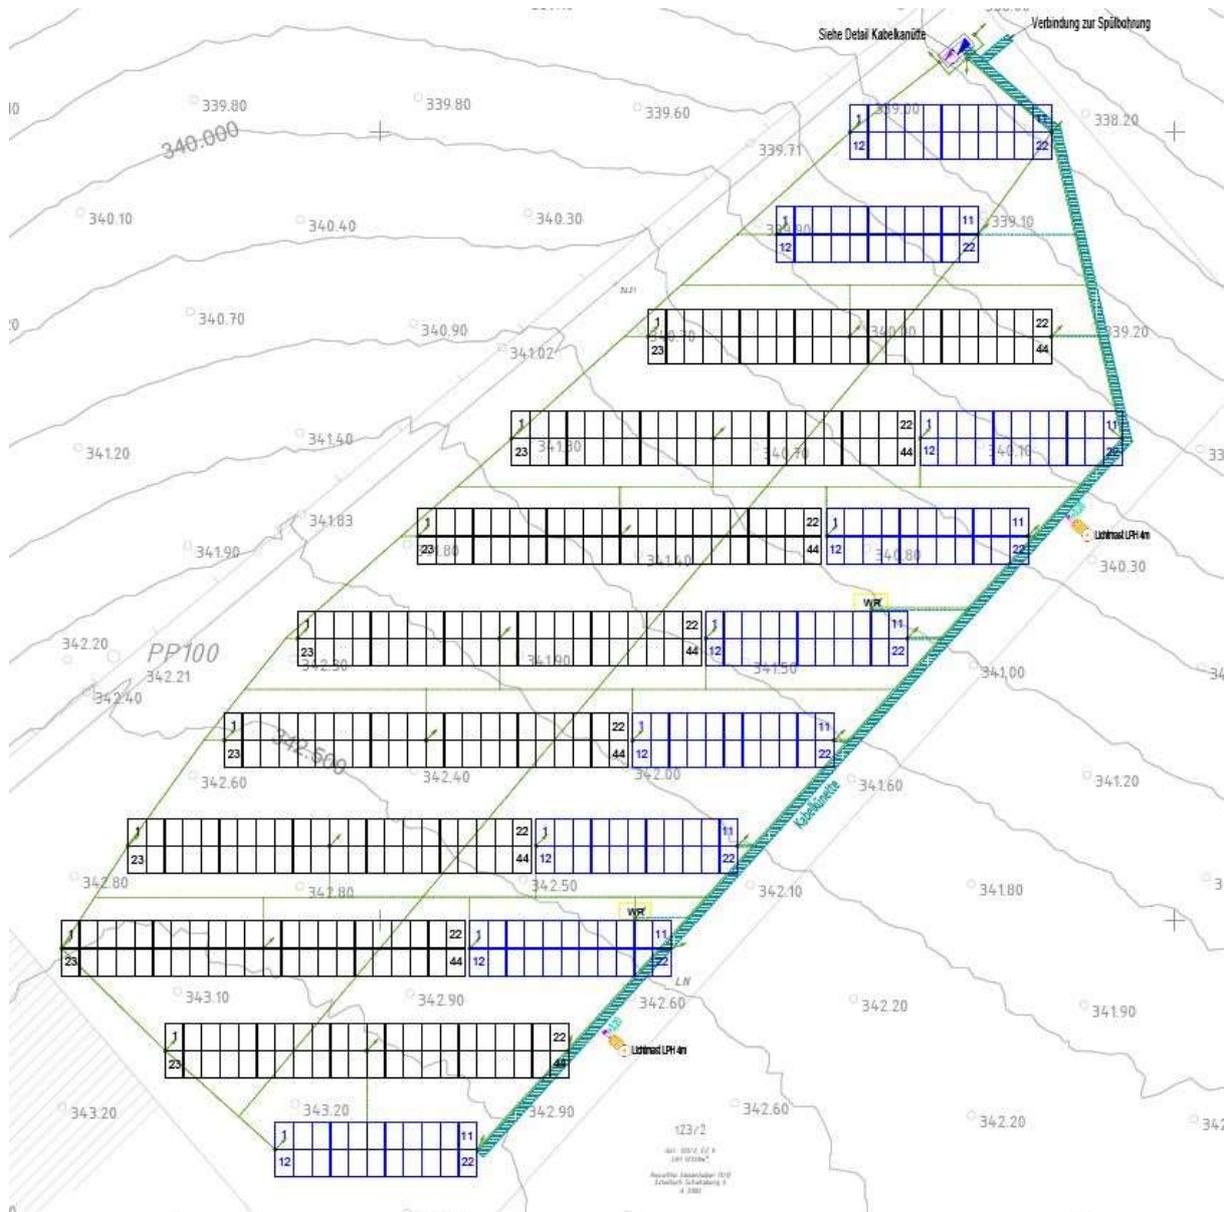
, Grundrissplan der geplanten PV-Freiflächenanlage
